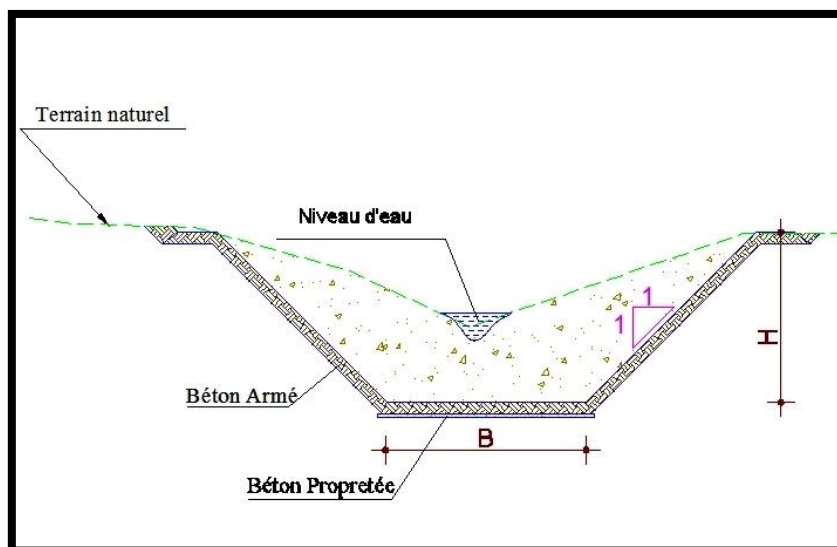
Schéma d'un canal trapézoïdal en béton armé.
